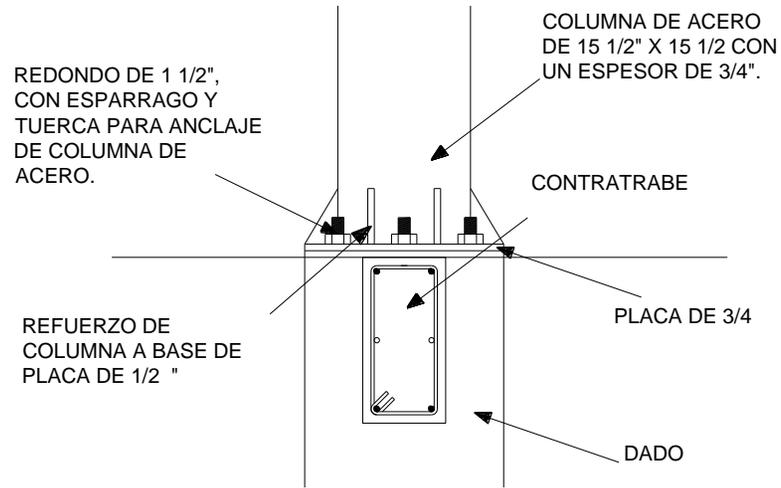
(cimentación) en la figura se muestran partes y diseño de construcción de zapatas aisladas.
